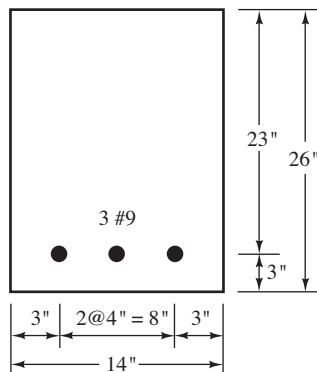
Sección transversal de la viga del Ejemplo 8.7.
